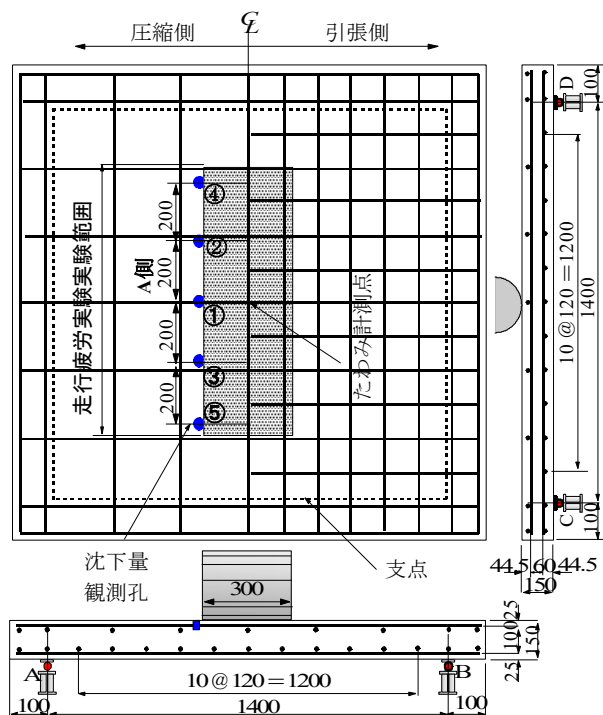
供試体寸法および水平ひび割れ計測位置
